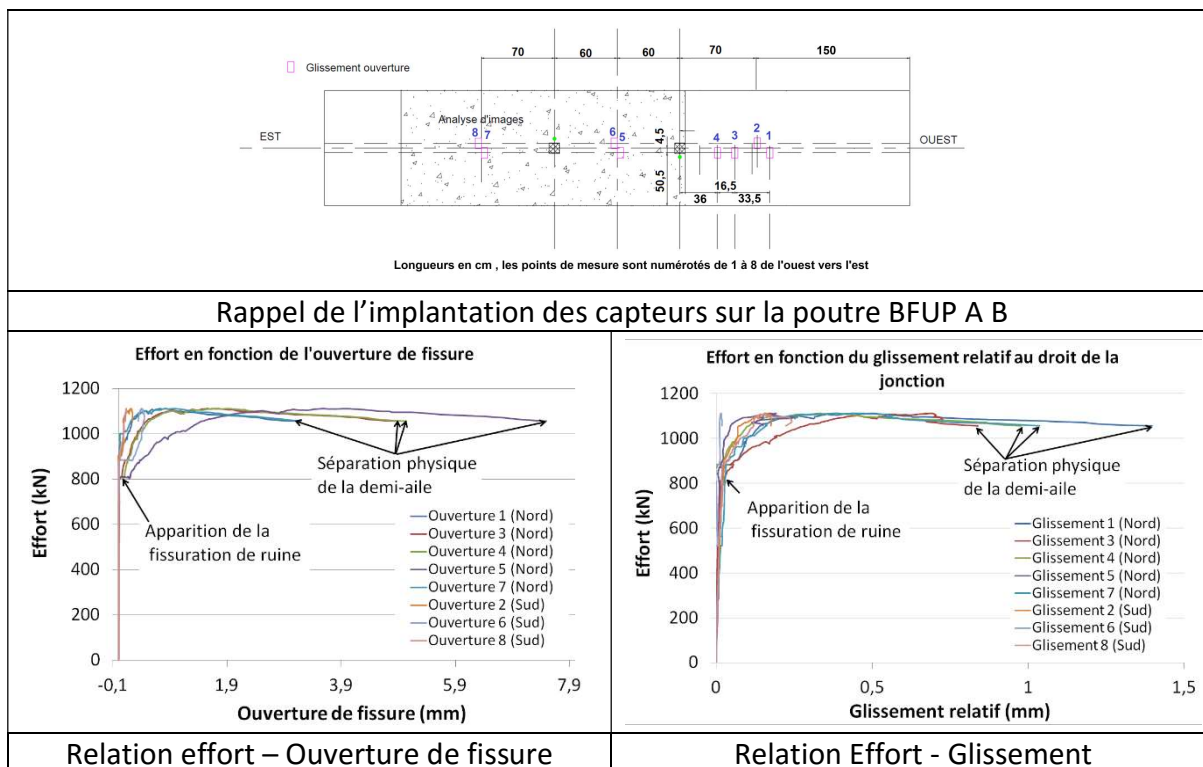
Evolution de la fissuration au droit de la jonction poutre BFUP A B
